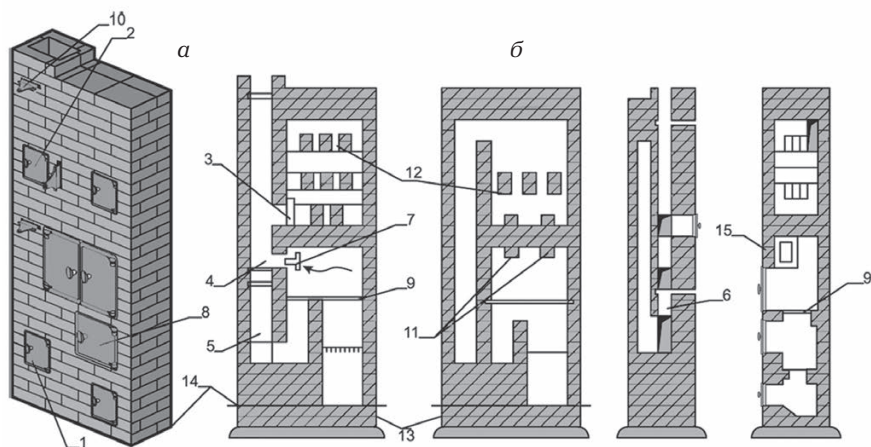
Обычная отопительно-варочная печь: а — общий вид; б — вертикальные разрезы; 1 — чистка; 2 — самоварник; 3 — зимняя задвижка; 4 — летняя задвижка; 5 — зимний ход; 6 — летний ход; 7 — вентиляция; 8 — топочная дверь; 9 — чугунная плита; 10 — дымовая задвижка для закрывания печи; 11 — стальные полосы 50×5 мм длиной 500 мм; 12 — кирпичная кладка на ребро; 13 — гидроизоляция; 14 — уровень пола; 15 — уголок
